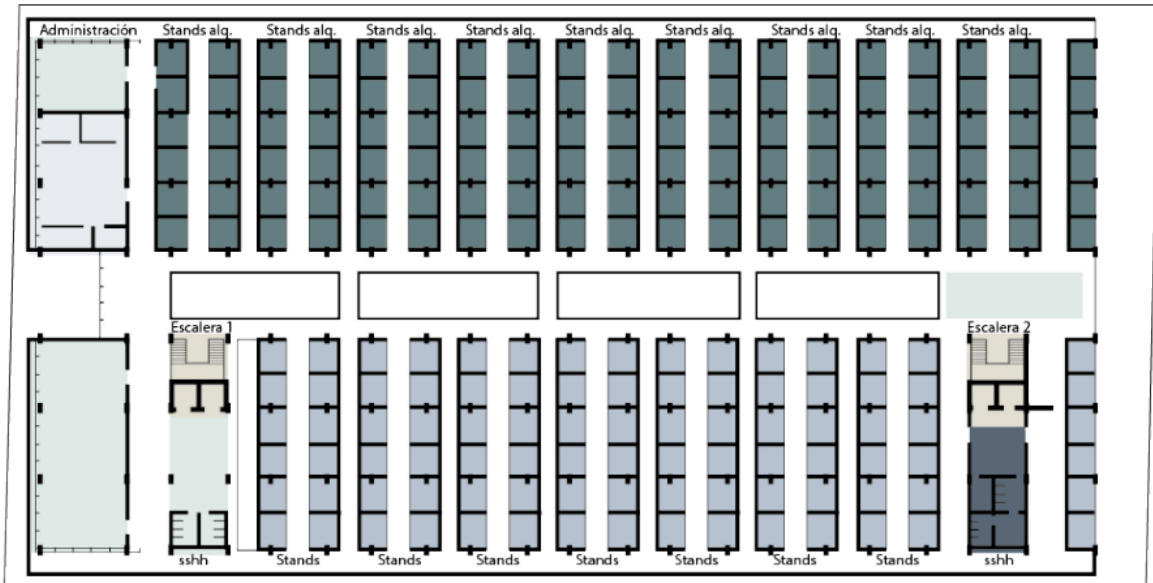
Planta arquitectónica – planta baja del proyecto Mercado El Ermitaño.
